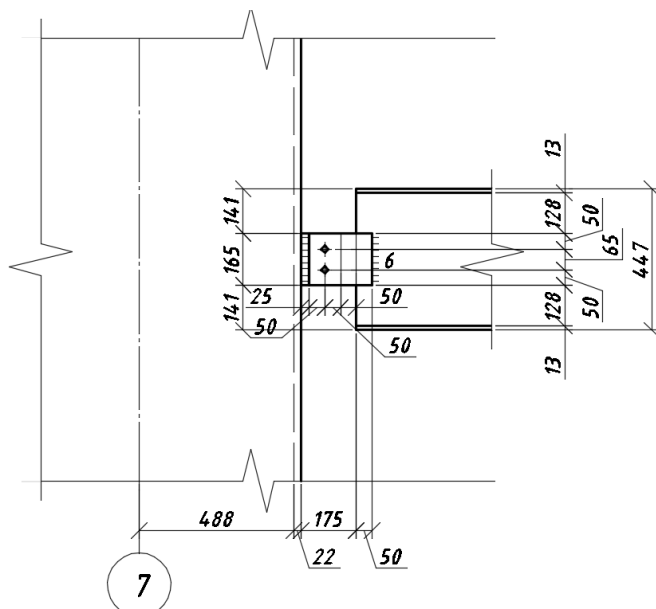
Примыкание балки БЗ к стойке 1 яруса
